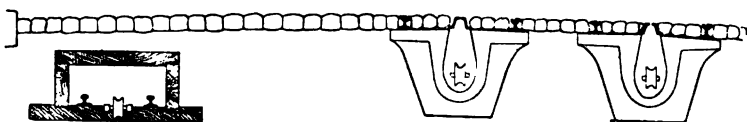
Installation à contrepoids de Providence. — Coupe transversale de la voie.
